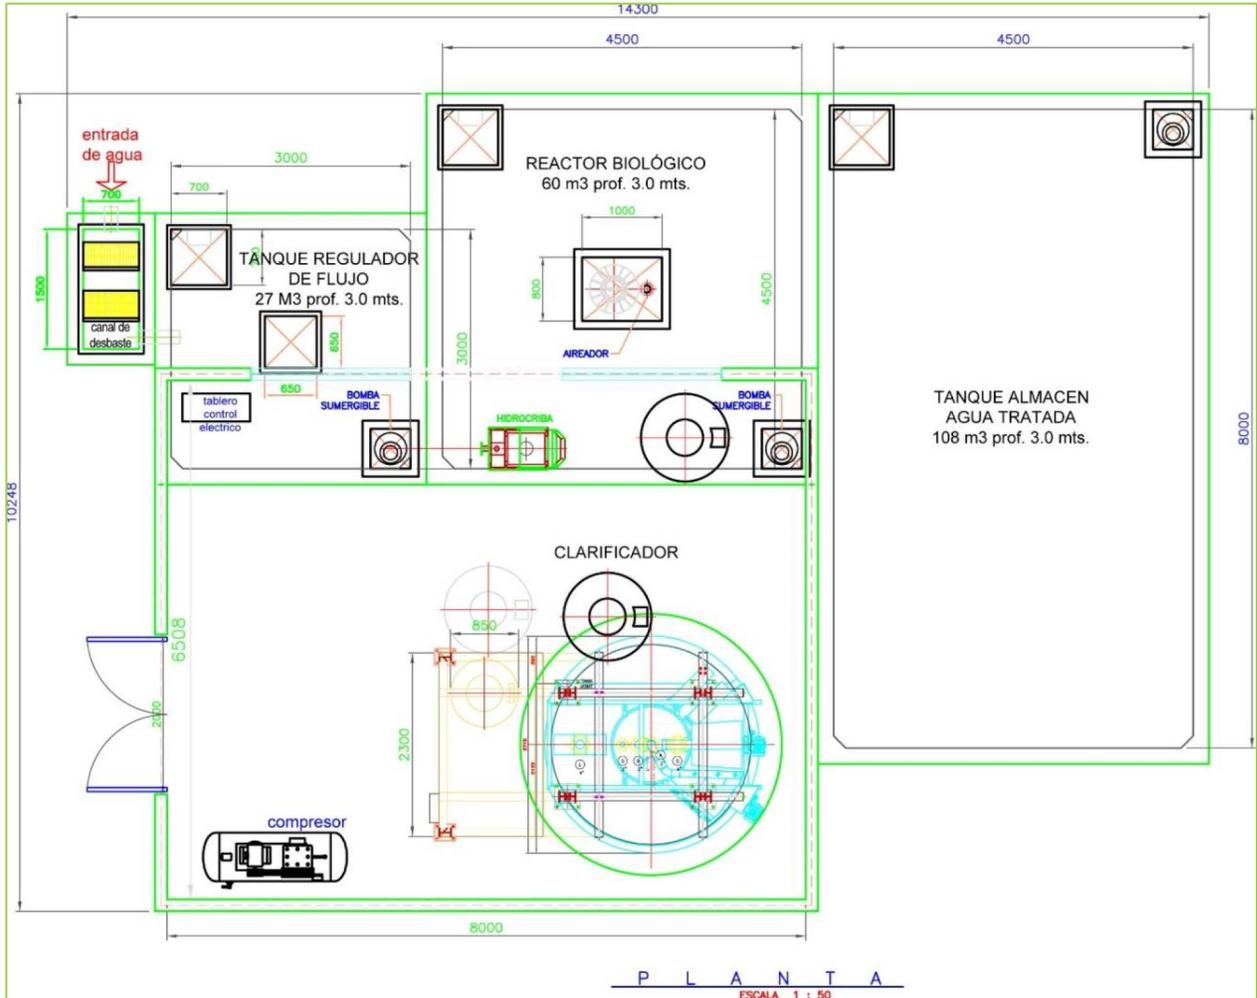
Se muestra la distribución de los componentes de la planta de tratamiento. Nota: las cotas de dimensiones se expresan en milímetros (mm). Propiedad de BIODAF.
